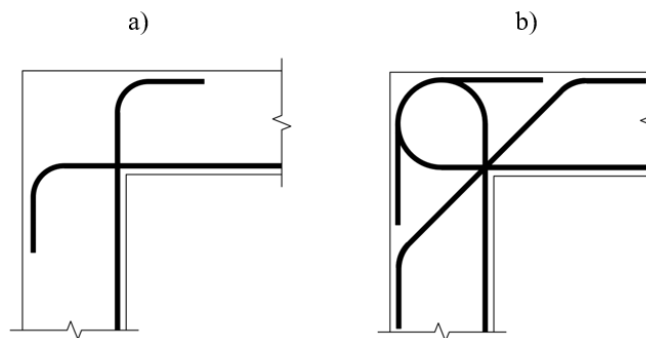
Pormenorizações de armaduras estudadas por Nilsson e Losberg.
